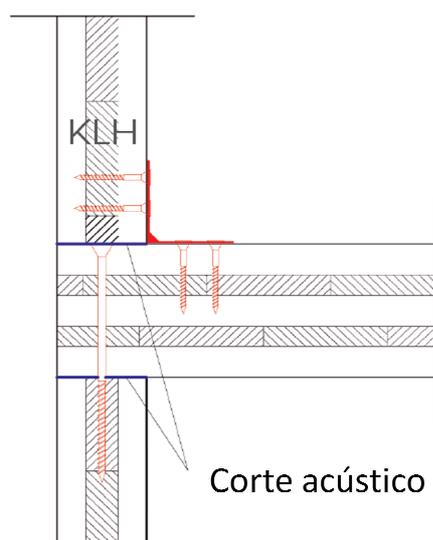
Pormenor construtivo de corte acústico. (KLH,2003)
